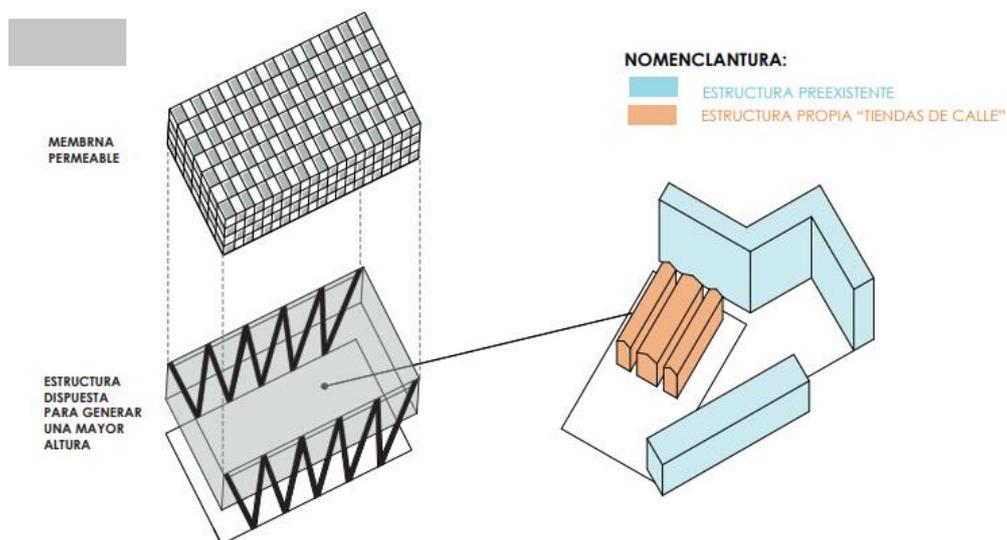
Diagrama Sistema Estructural. Elaborado por grupo de estudiantes Taller Avanzado
